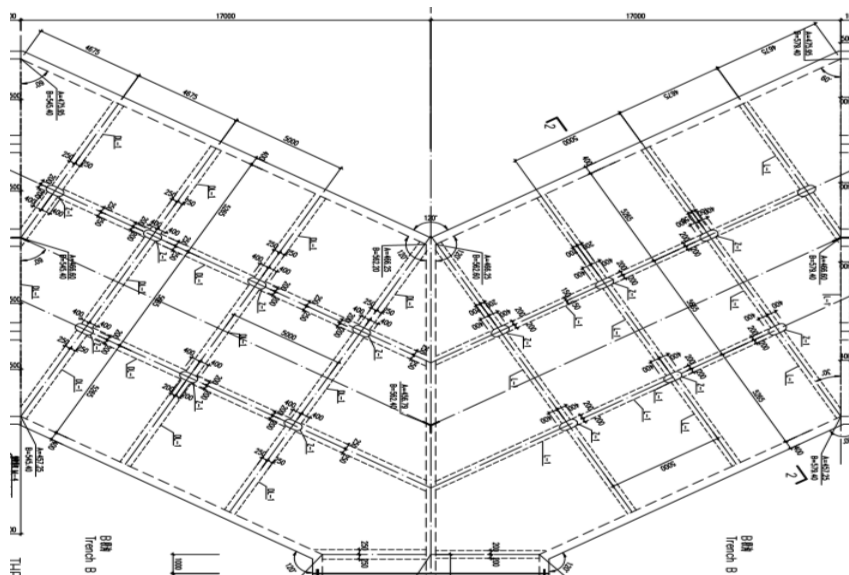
Planta do Troço-B da CCC do Soyo.
